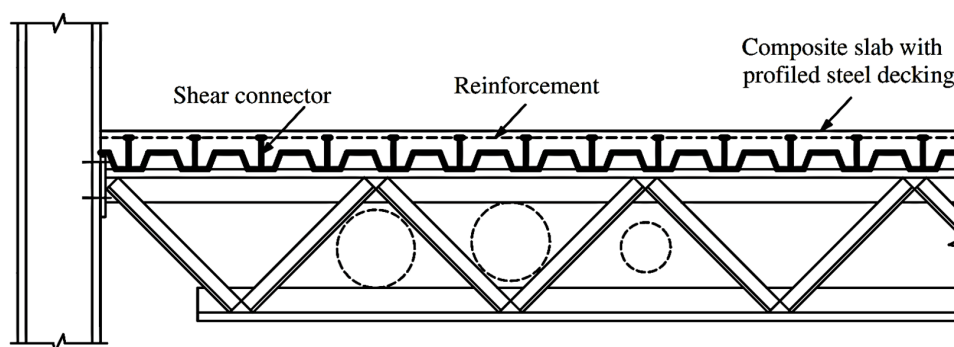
Exemplo de vigas mistas com recurso a treliça metálica (adaptado de Chung, 2002).
